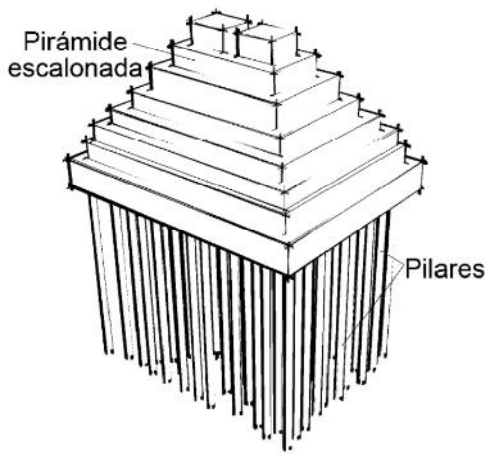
Construcciones aztecas con pilotes de madera en los basamentos.
